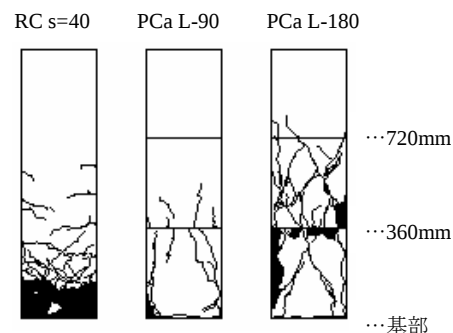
載荷終了時におけるひび割れ状況の一例
